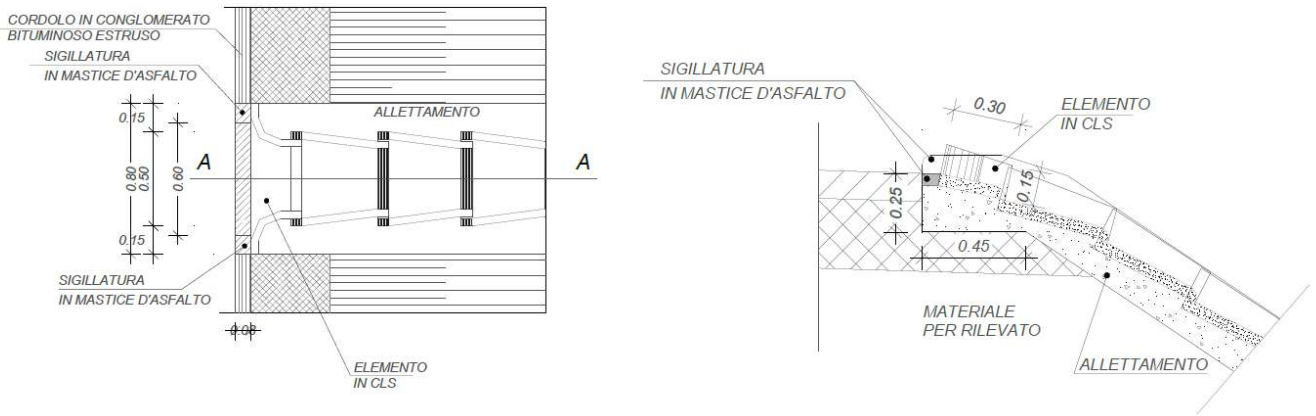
Dettaglio in pianta e sezione testa embri su piattaforma ferroviaria
